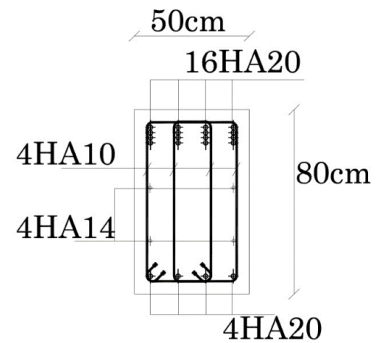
Plan de ferrailage des nervures suivant X.
